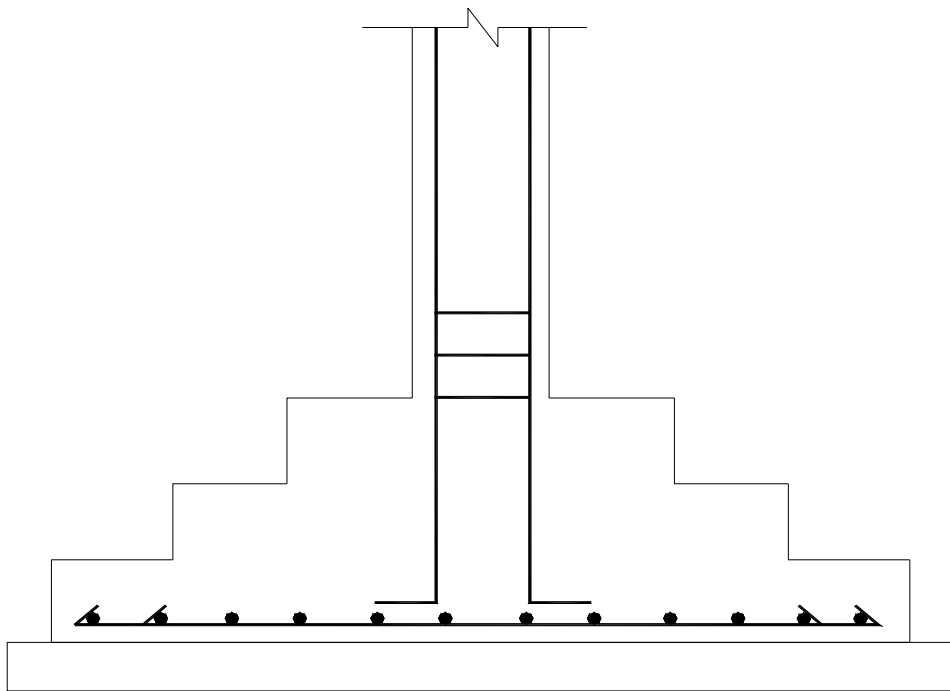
独立柱基础钢筋绑扎示意图 1
